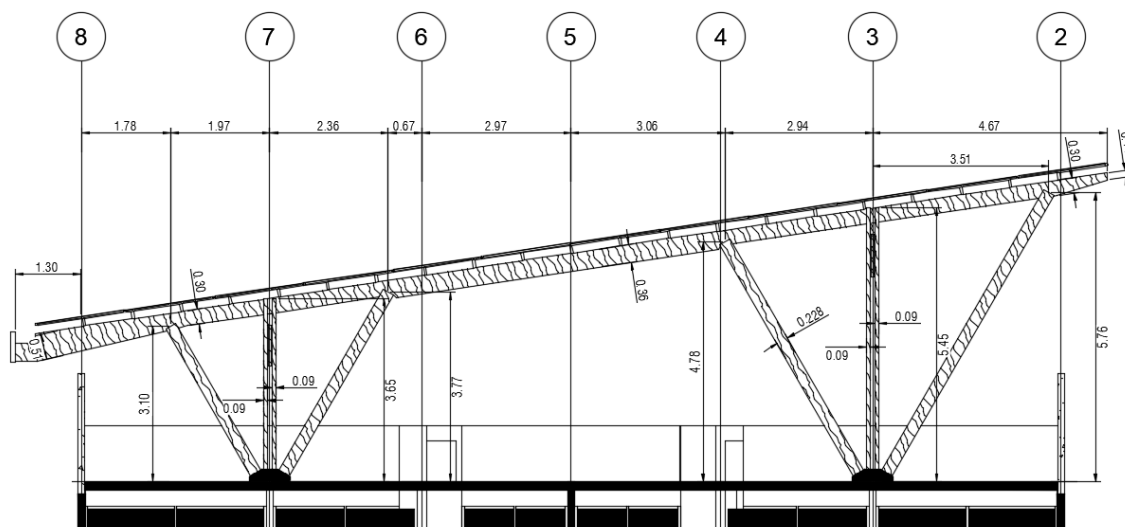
Marco típico de estructura soporte de la cubierta en Azotea. Fuente: Elaboración propia
